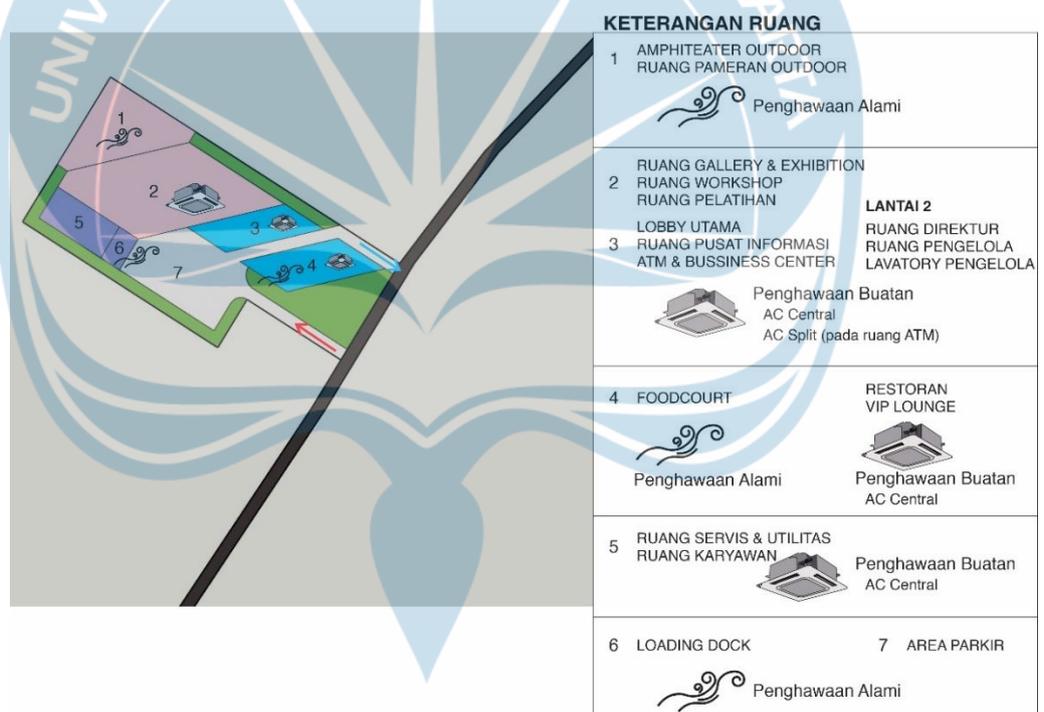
Tata Ruang Bangunan Skematik (Blockplan) pada Lantai 2
